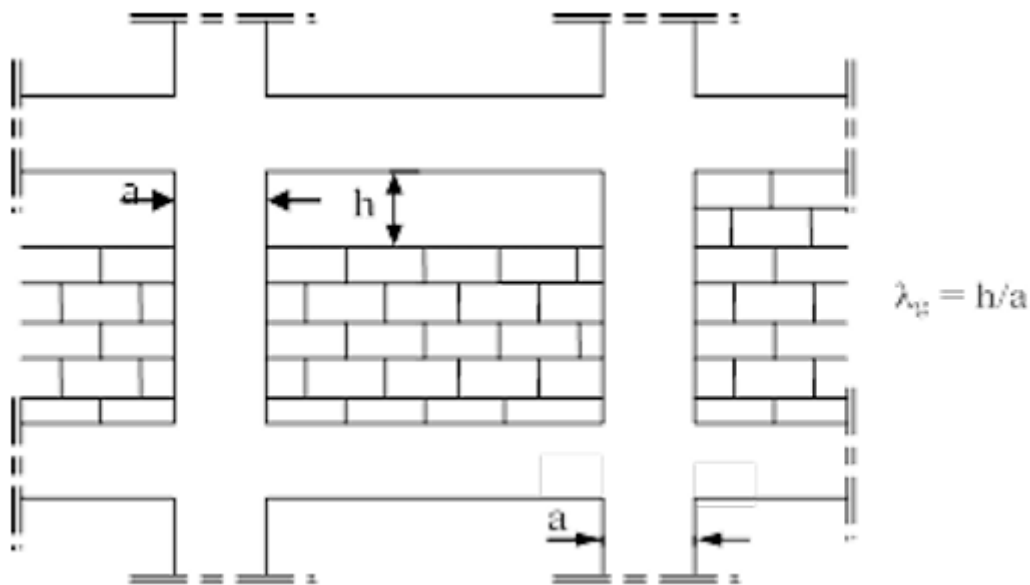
cas de constitutions de poteaux court, par hauteur insuffisante de la maçonnerie de remplissage.
